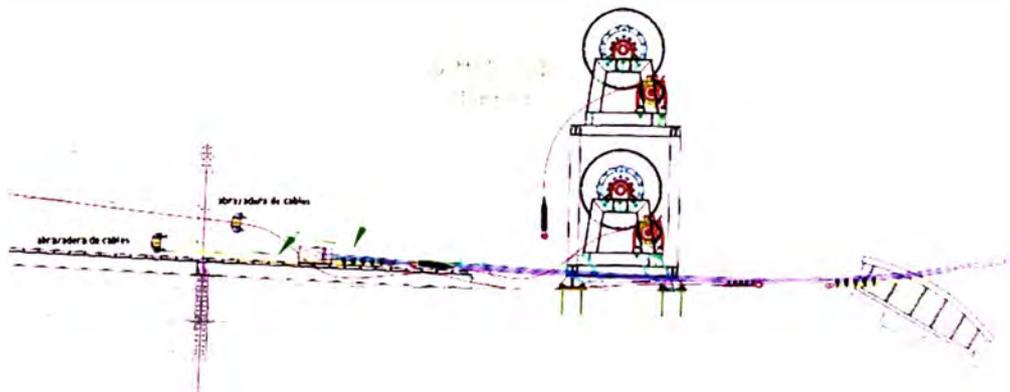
ESQUEMA TRASLADO CABLE PORTANTE
